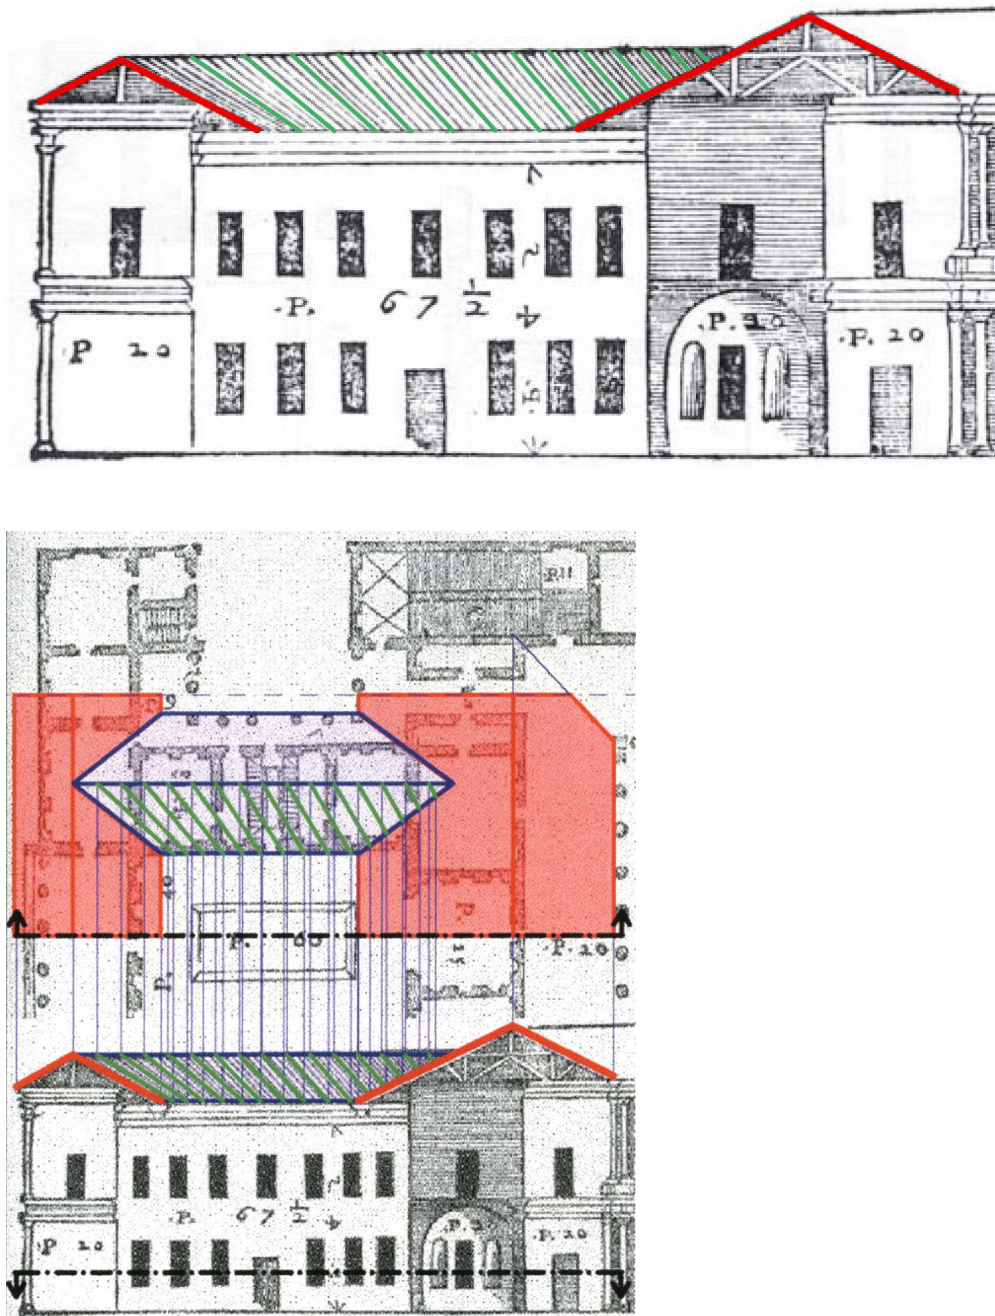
Toskanisches Atrium. Detail des Daches. (Nachgezeichnung und Markierungen, Ausschnitt der Autorin nach Zich 2009: Abb. 4).
